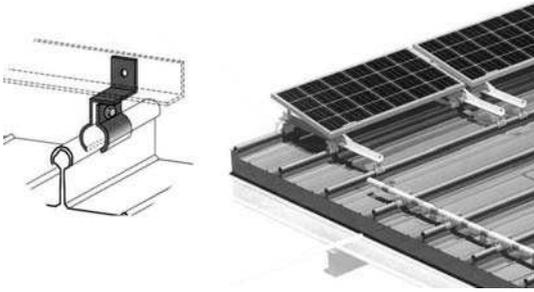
Mittels Klemmvorrichtung auf einer Deckung aus Aluminium-Stehfalzdeckung installierte Solarmodule
